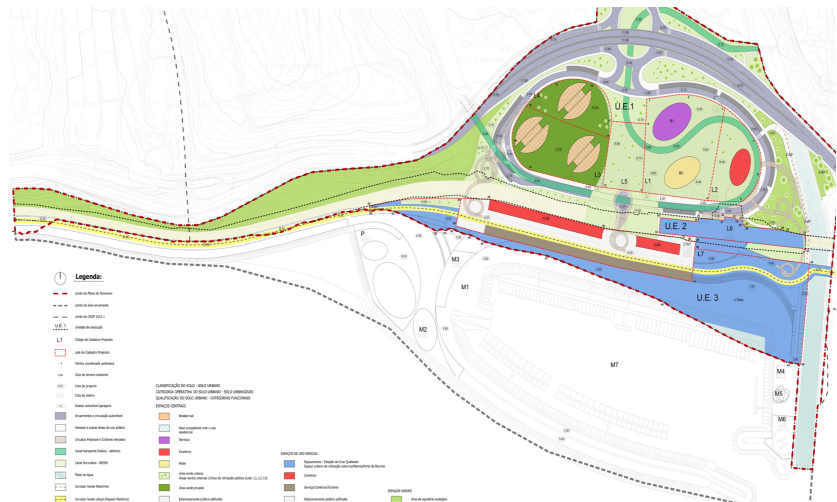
Plano Pormenor da Margem Direita da Foz do Rio Jamor. Fonte: Plano Estratégico Doca de Pedrouços, CML, 2011.
